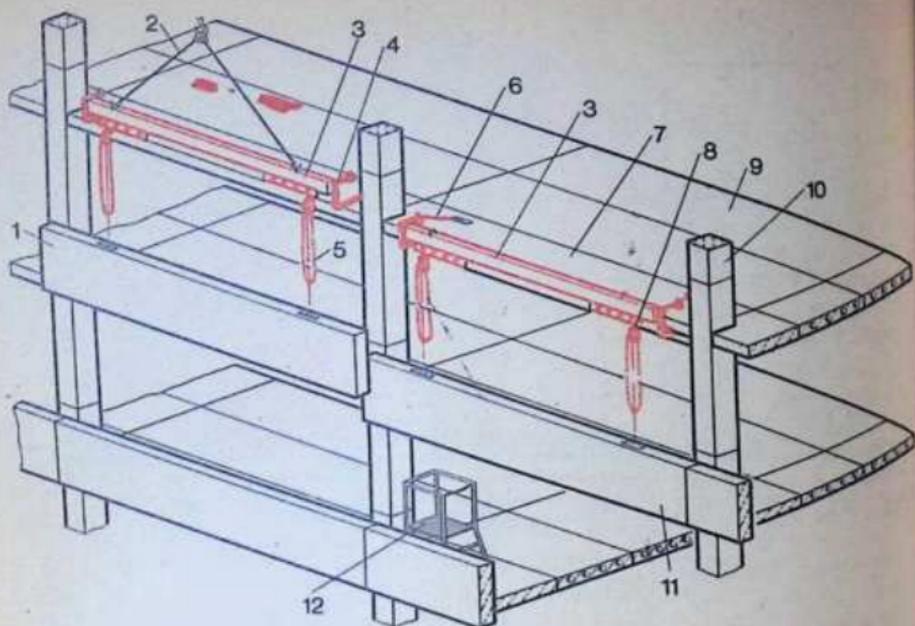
Схема установки панелей с помощью траверсы с поддерживающими приспособлениями:
